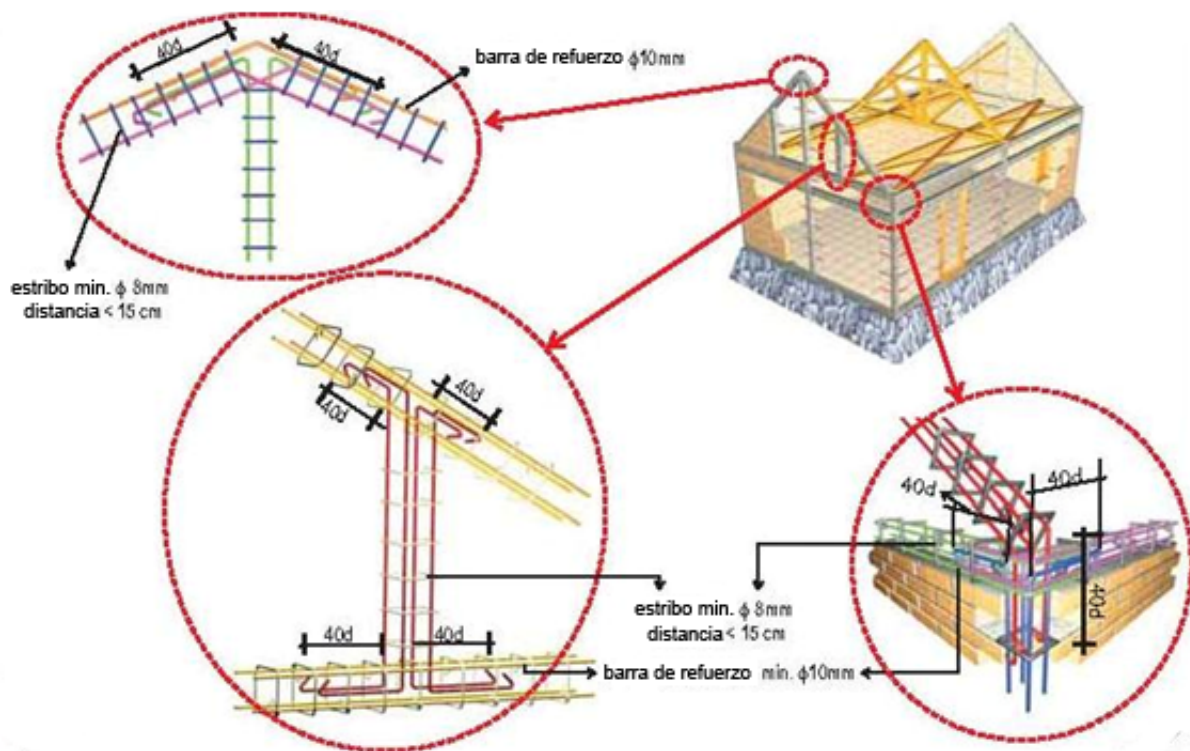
Detalle de las barras de refuerzo longitudinal en distintos sectores de los elementos de confinamiento de un tímpano (Boen, 2009)
